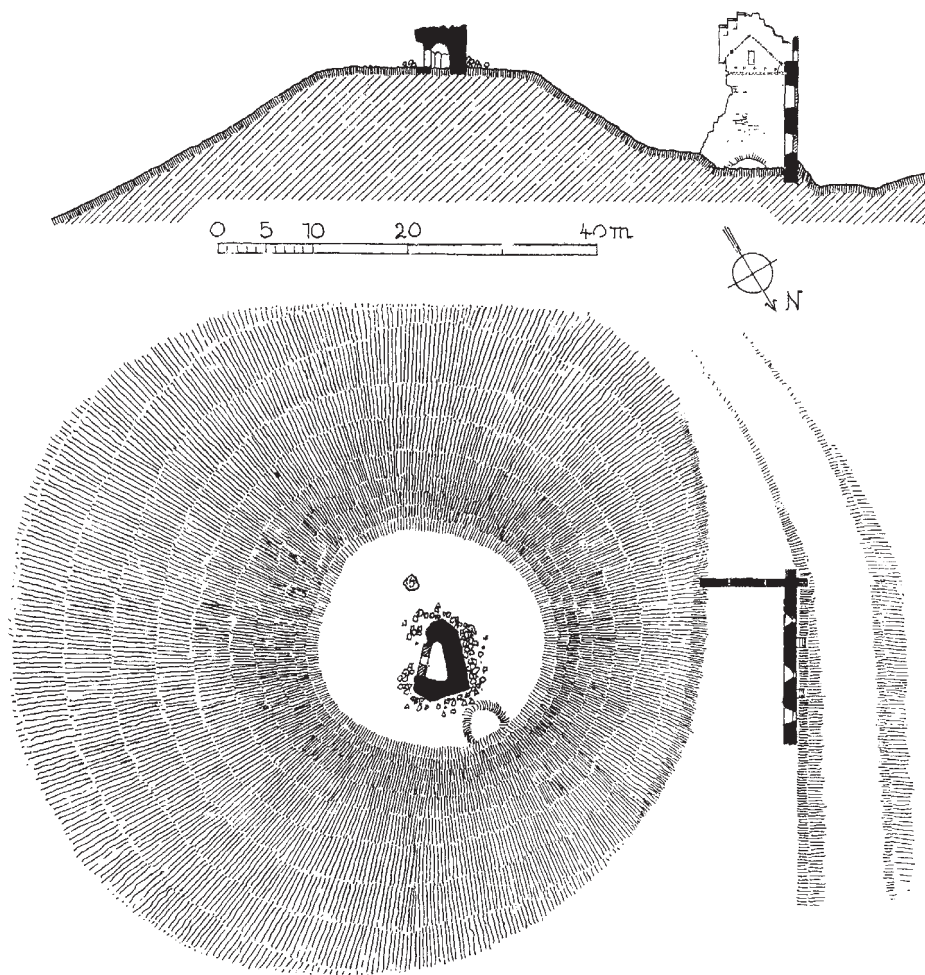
Lewenstein: Lewenstein. Grundriss und Schnitt.
